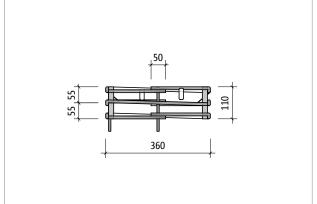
Schöck Sconnex® type P-B400 : vue latérale Part T; étrier soudé et segments flexibles en acier inoxydable
